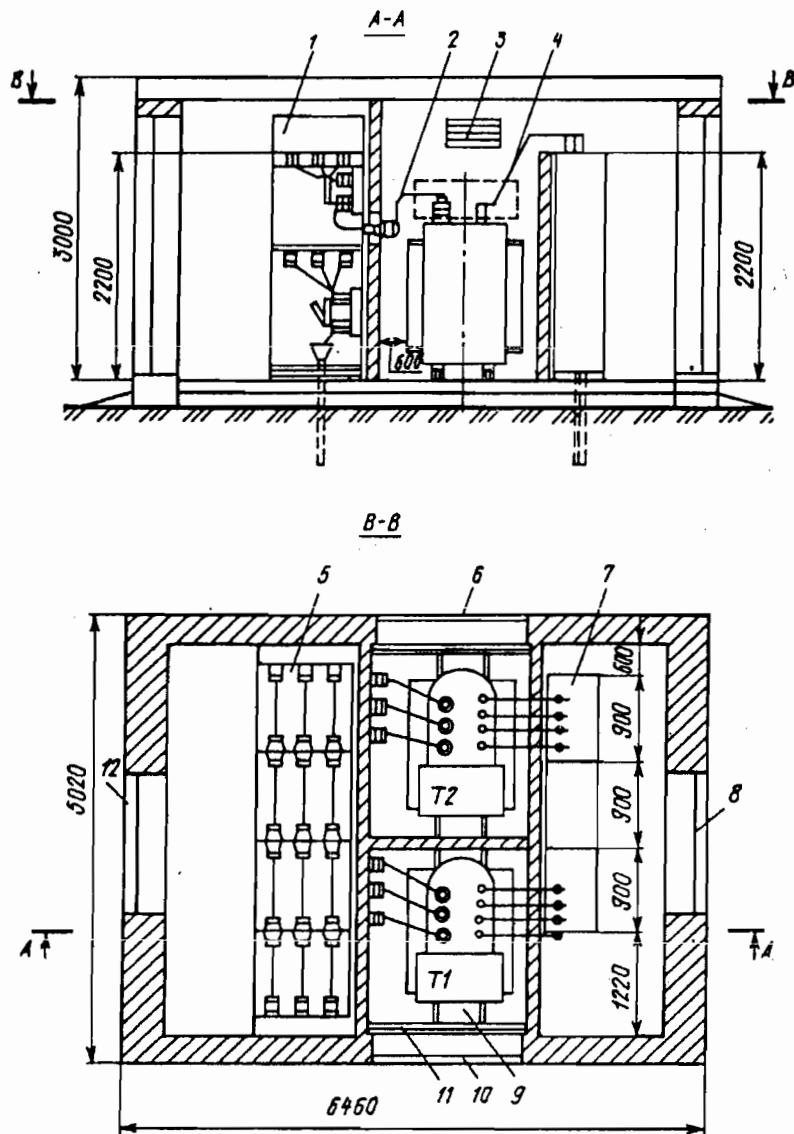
Габаритные, установочные и присоединительные размеры подстанции ЗТПС-10-2Т2К:
